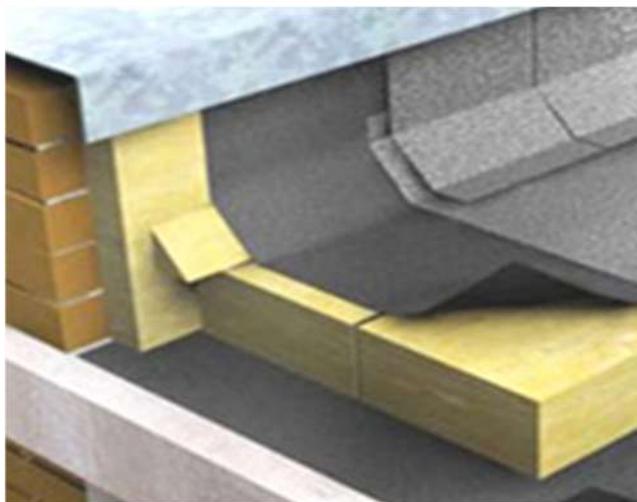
Фрагмент теплоизоляционной конструкции покрытия
